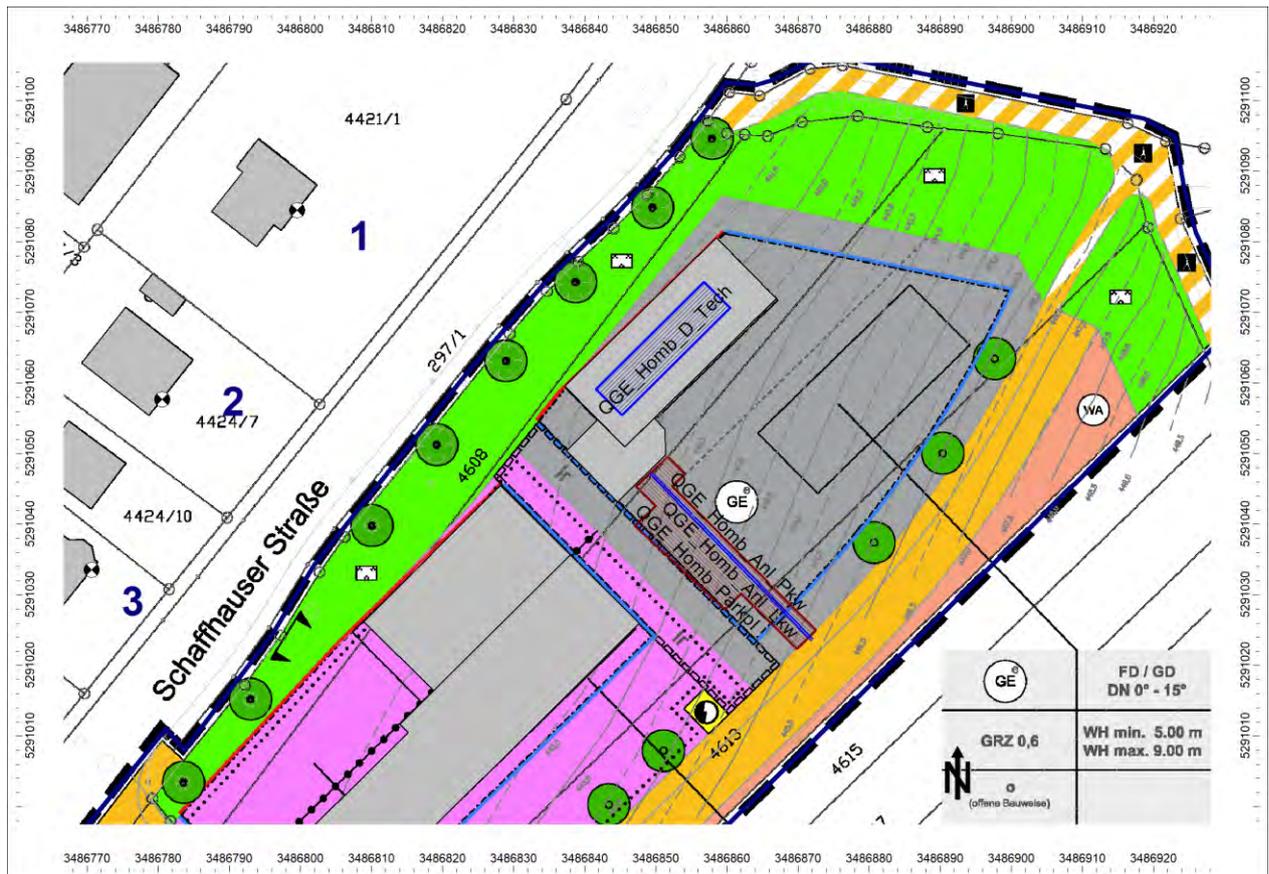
Lageplan Schallquellen Bestattungshaus Homburger
